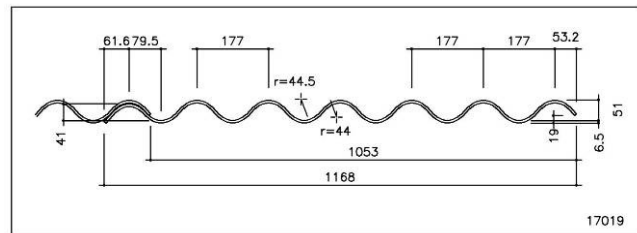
Plaque ondulée ECOLOR EXTRA profil 177/51 – coupe onde descendante rabaissée gauche et onde descendante droite
